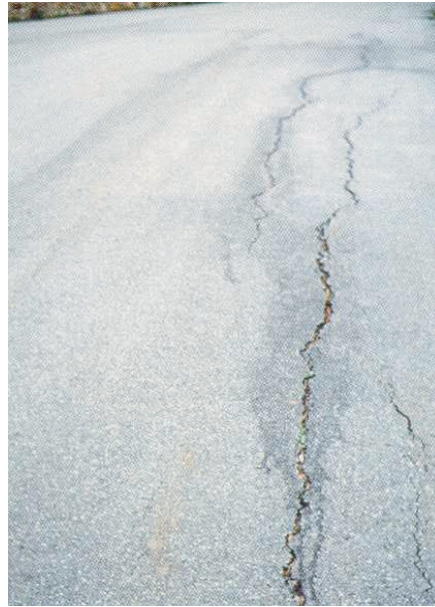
Fissuration longitudinale sur une chaussée
